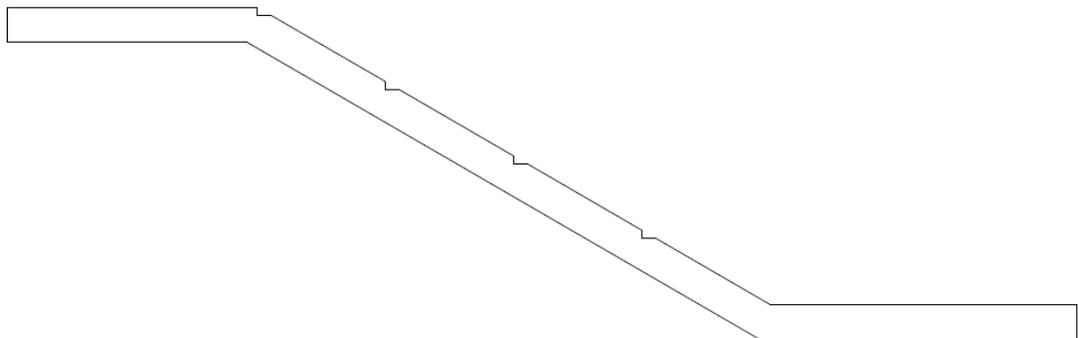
Geometría de la viga inclinada del pórtico porta-gradas (dimensiones en cm)
